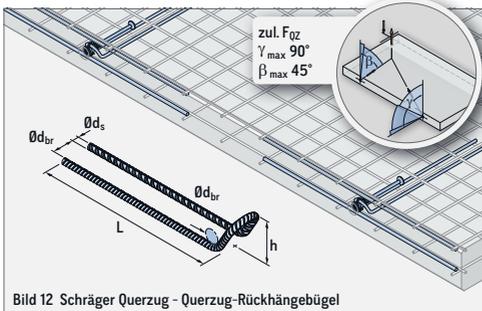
Schräger Querzug - Querzug-Rückhängebügel
